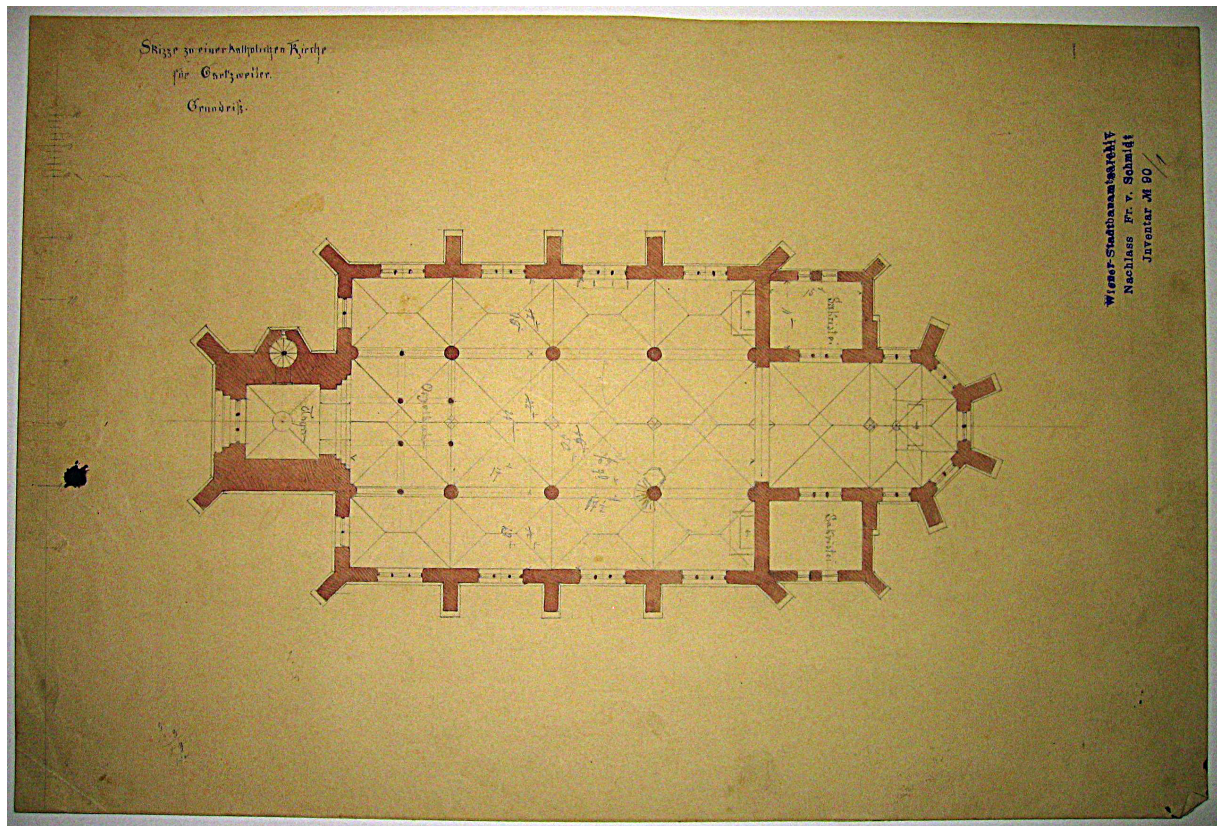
WM, Inv.-Nr. 157.90/1 Grundriss
